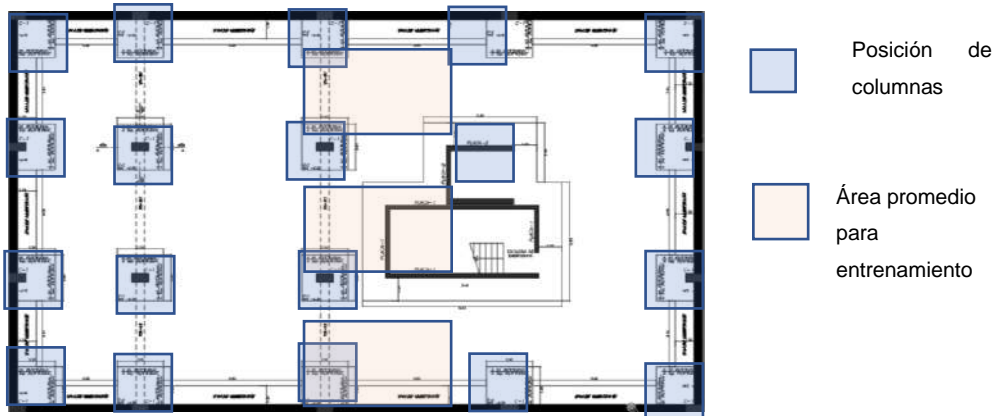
Análisis de estructuras en plantas del sector asignado, elaboración propia
